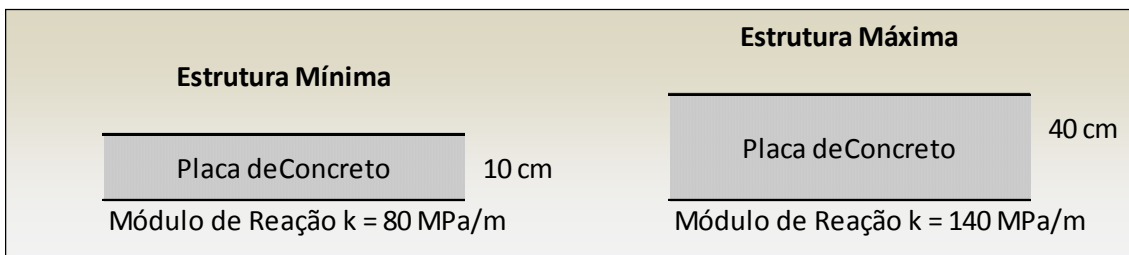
Estruturas mínima e máxima de pavimento rígido
